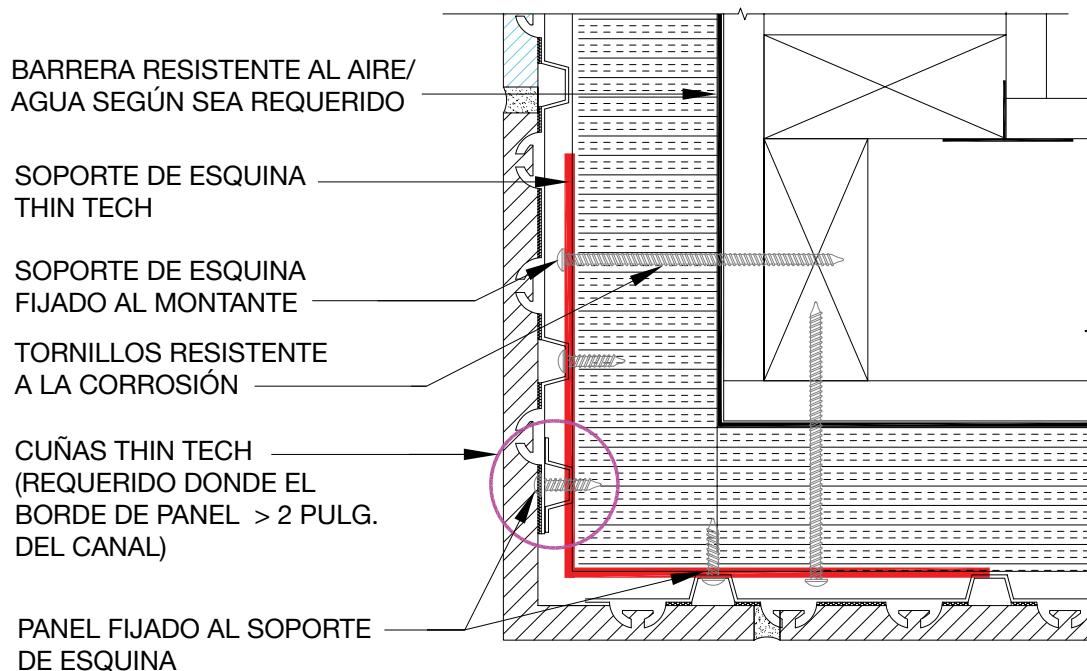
DETALLE SOBRE LA FIJACIÓN DE SOPORTE DE ESQUINA
